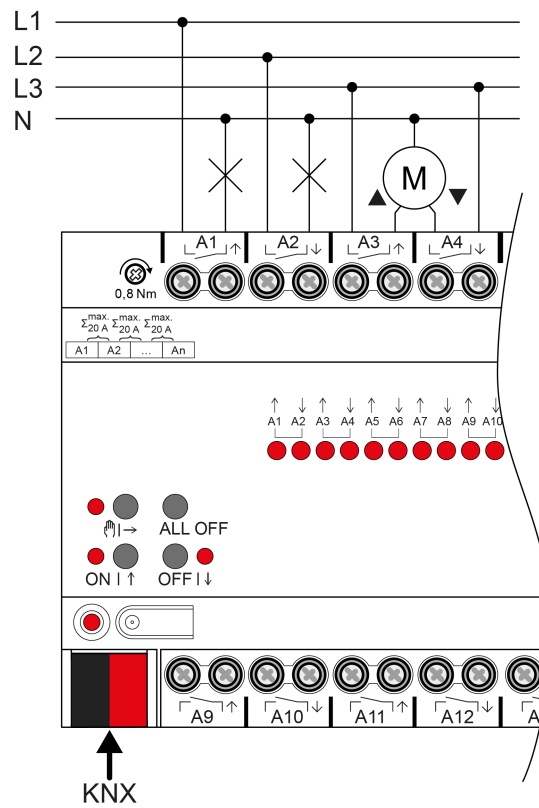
Collegamento dell'apparecchio (esempio di collegamento)
